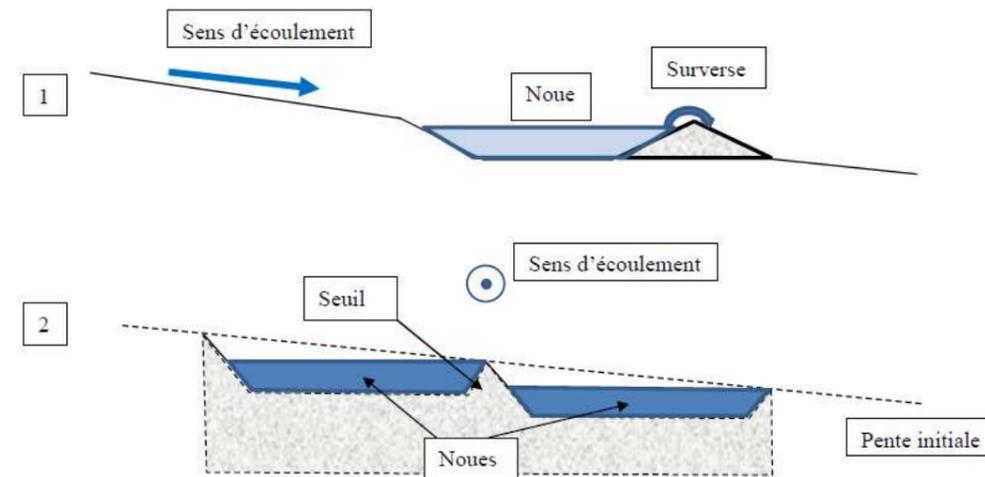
PHOTOGRAPHIE, COUPE TRANSVERSALE (1) ET LONGITUDINALE (2) D'UNE NOUE A SEUIL
